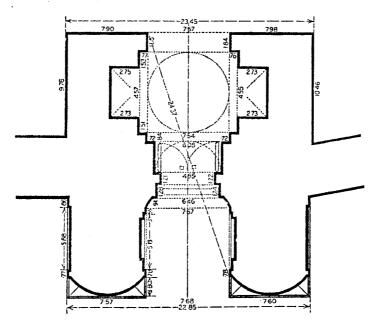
مسقط أفقي لوكالة الغوري بالقاهرة . (الطابقان الأرضي والأول) (عن المعي) .
